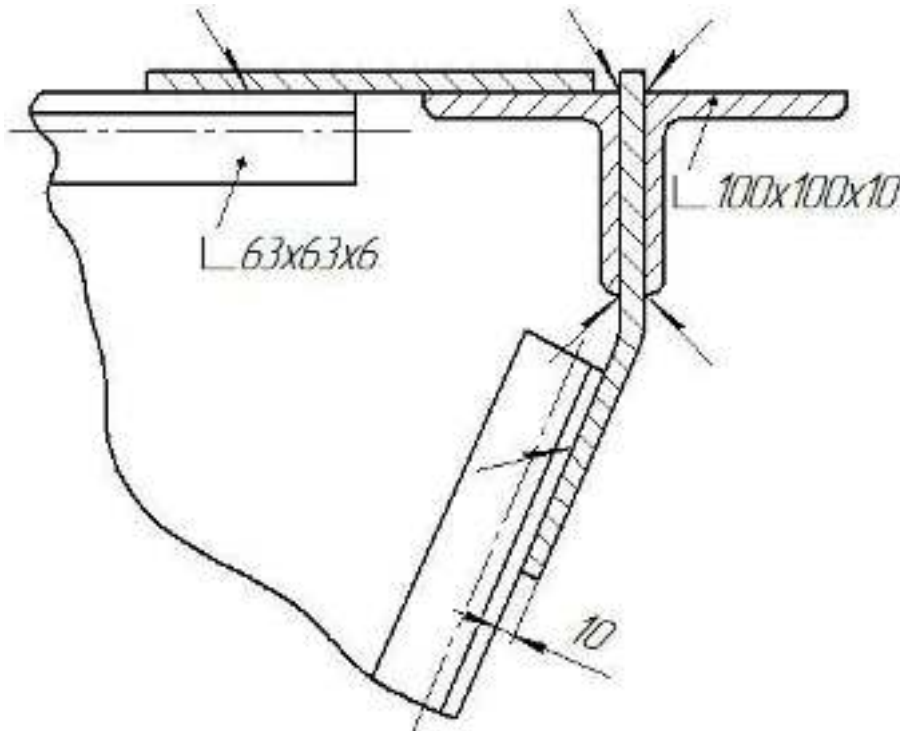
Поперечний перетин верхнього поясу
